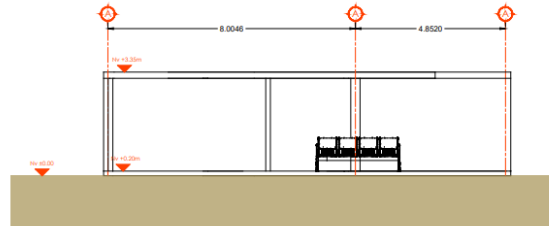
Plano Arquitectónico Área de Bodegas y Crematorio
